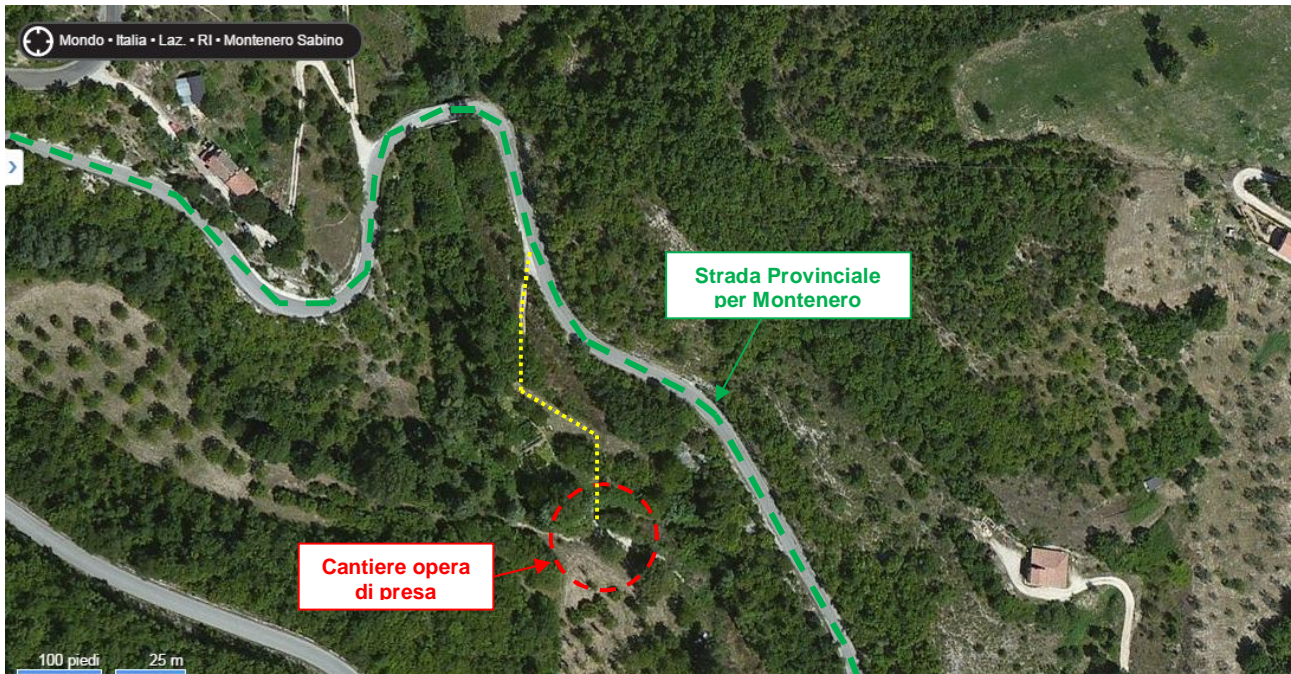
Area di cantiere opera di presa ed accesso dalla Strada Provinciale per Montenero.
